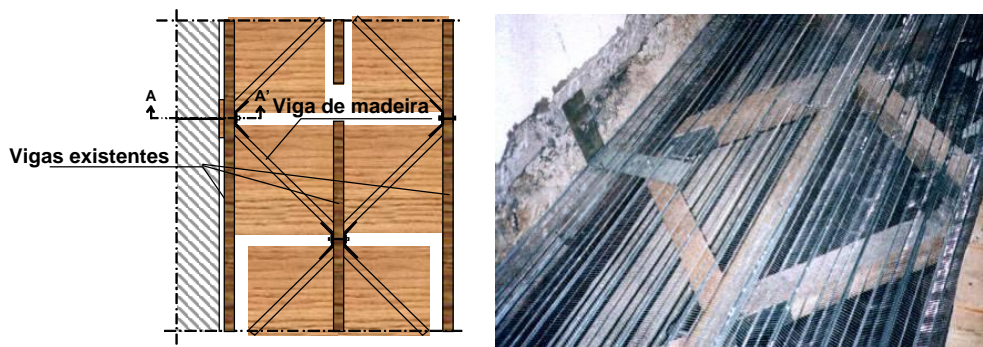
Estrutura de treliçada de madeira (IC)
